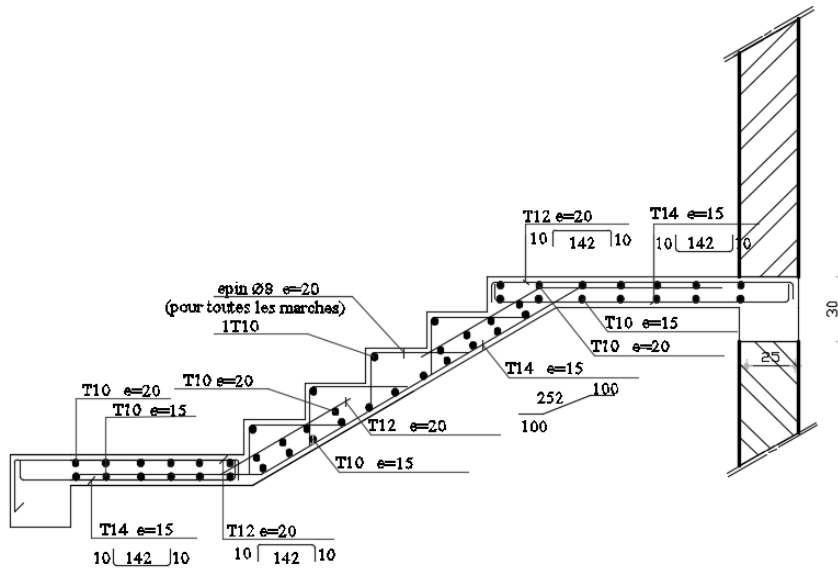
Dessin de ferrailage de l'escalier
